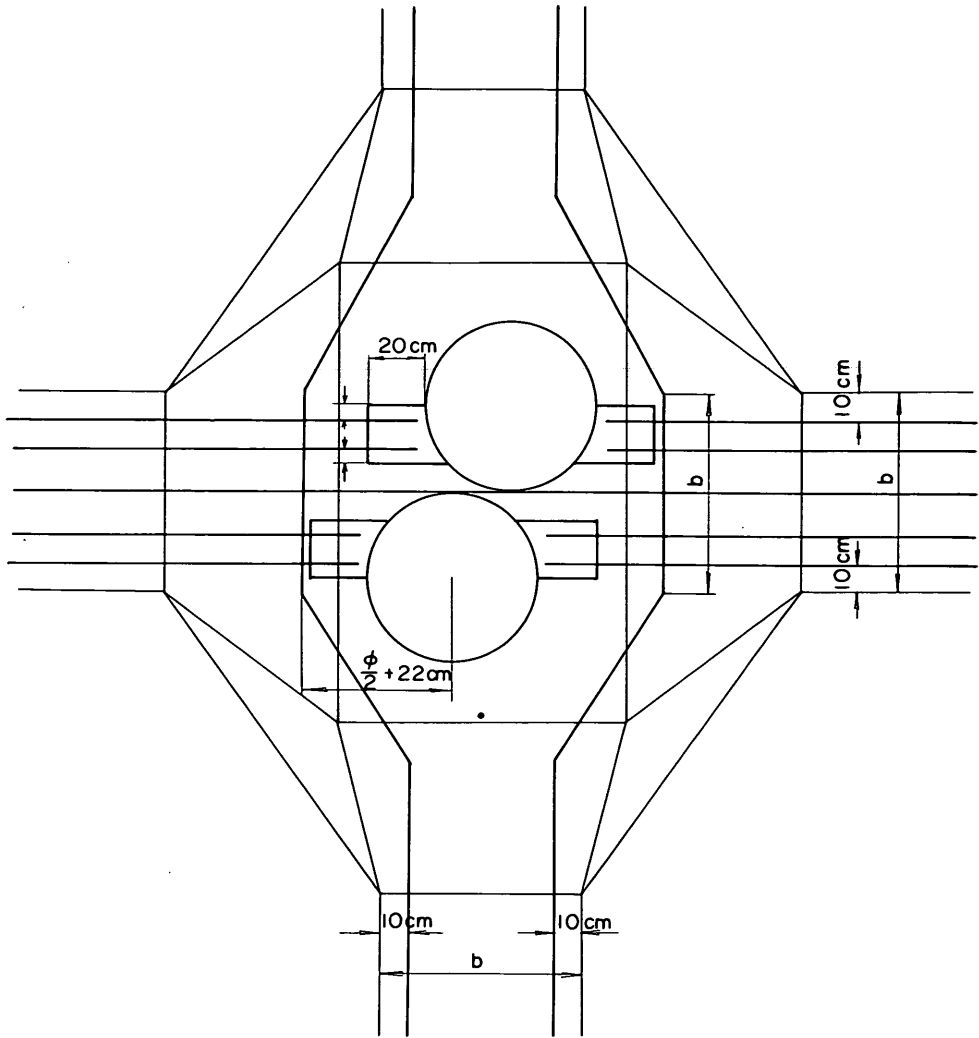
施工鉄筋の形状 (斜ぐい部)
